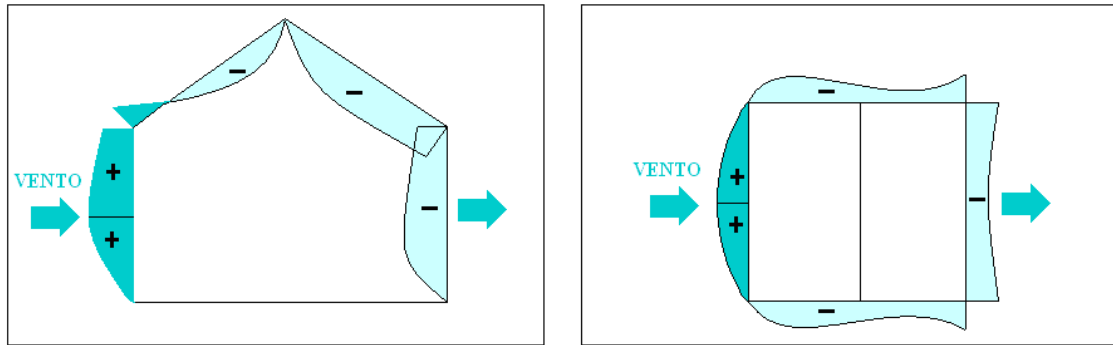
Fluxo de ar e zonas de pressões por ação do vento em corte e em planta (26)
